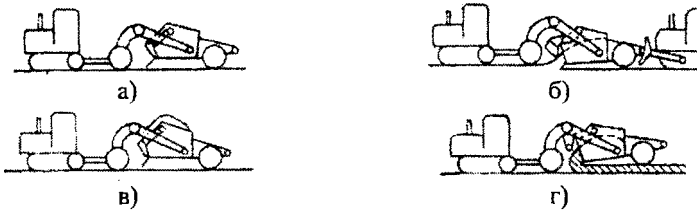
Рабочий цикл скрепера с загрузкой движущим усилием: а - порожний ход; б - загрузка; в - груженный ход; г- разгрузка
